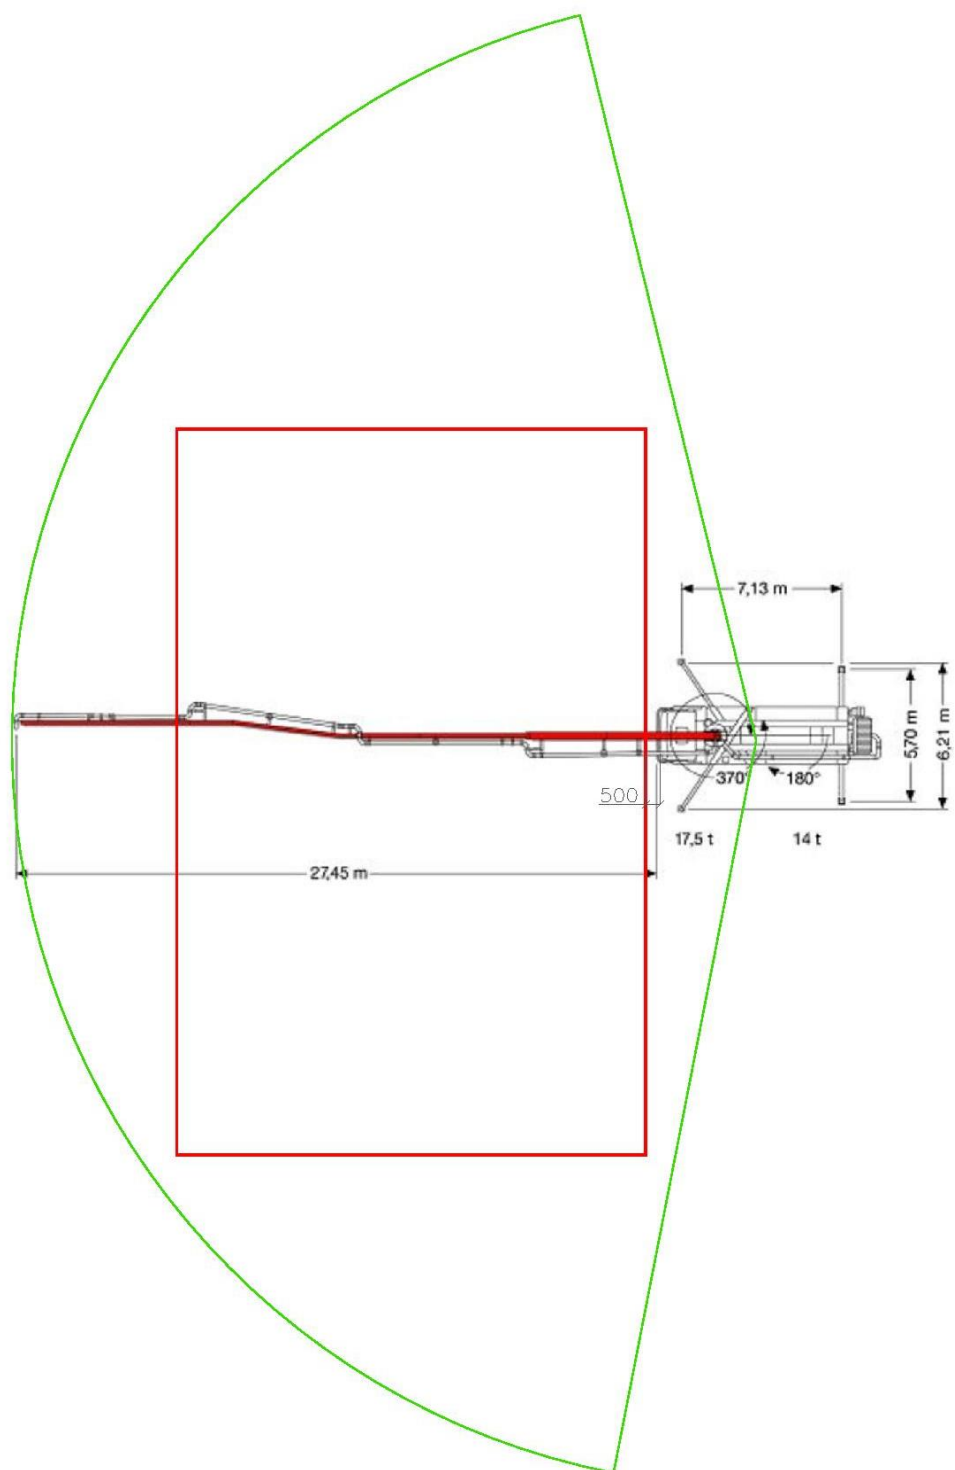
Rozměry Autočerpádkla SCHWING S 34 X [5]
